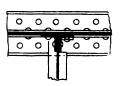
stellt einen rechtwinkligen, Abb. 213 einen schiesen Anschluß zweier Winkeleisen dar. Der Anschluß zweier L-Eisen nach Abb. 214 u. 215 wurde mit Hilfe eines unter die beiden Horizontalflanschen genieteten Knotenbleches erreicht, wobei die Flanschen des angeschlossenen Profils entsprechend abgeschnitten werden mußten, um die Stege mit Winkeleisen verbinden zu können. Die Verbindung der beiden
